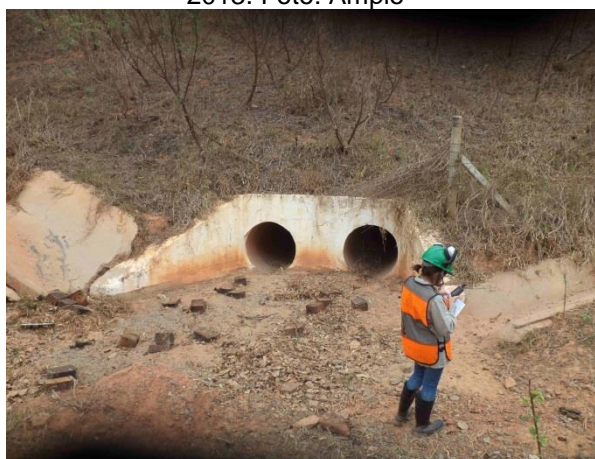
Montante da travessia 174, em outubro de 2013. Foto: Ampla
